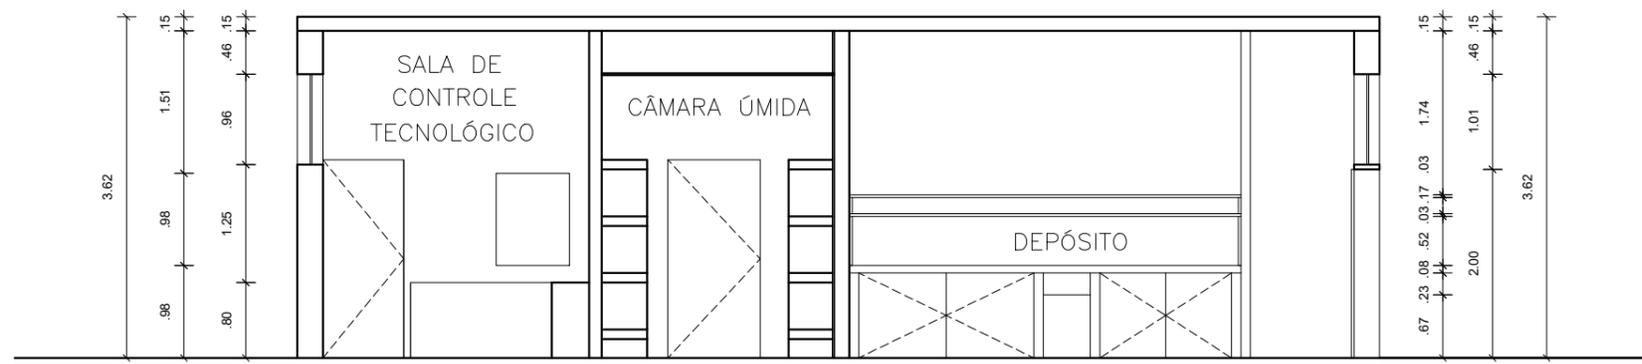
Proposta de Requalificação - Cortes Transversais 02
